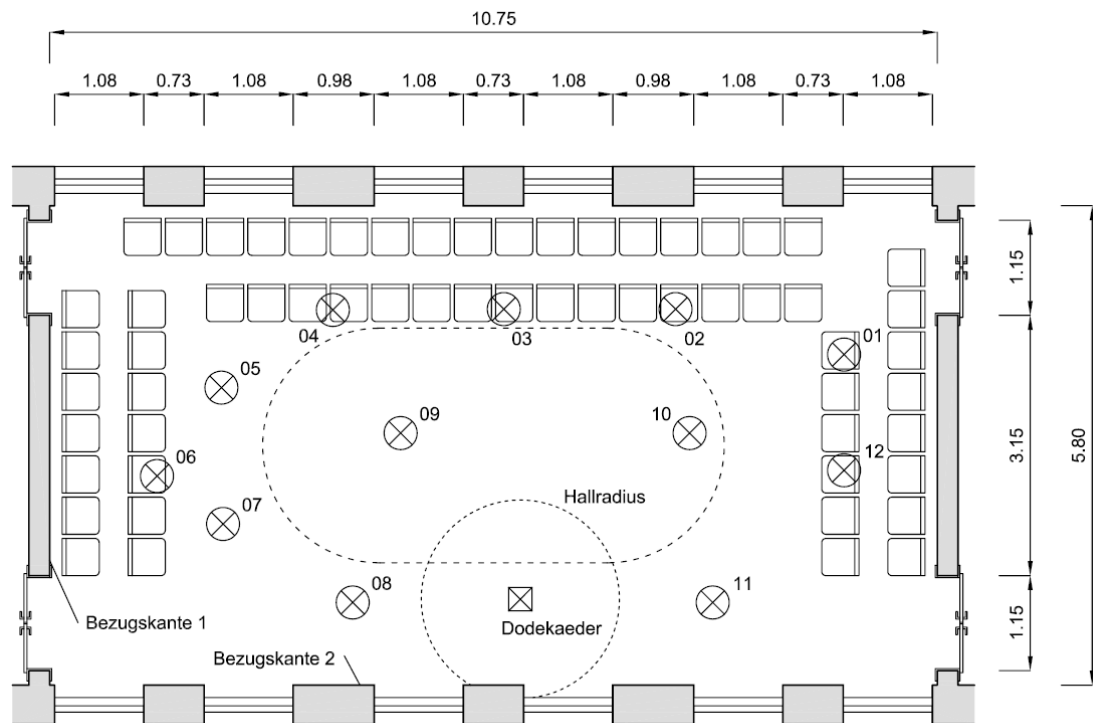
Grundriss des Sommersaales im Bosehaus mit Lage der Messpositionen
